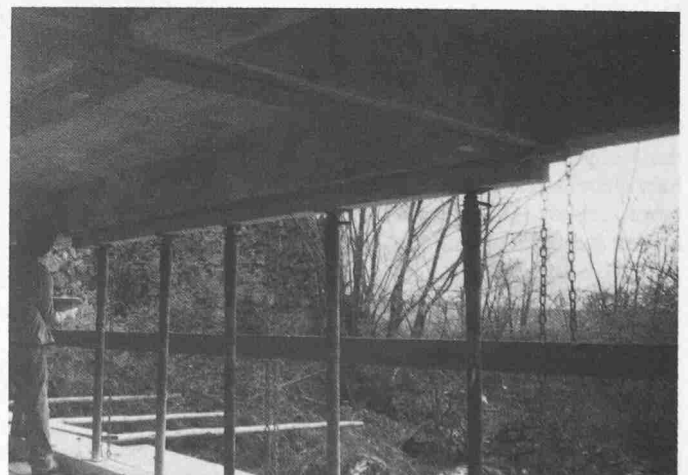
Anpressen der Bleche an den Konstruktionsbeton. Mit den Deckenspriessen und dem Kantholz wird ein gleichmässiger Anpressdruck erreicht. Die Spriessen stützen sich auf dem Gerüst ab, das mit Ketten an der Brücke befestigt ist
